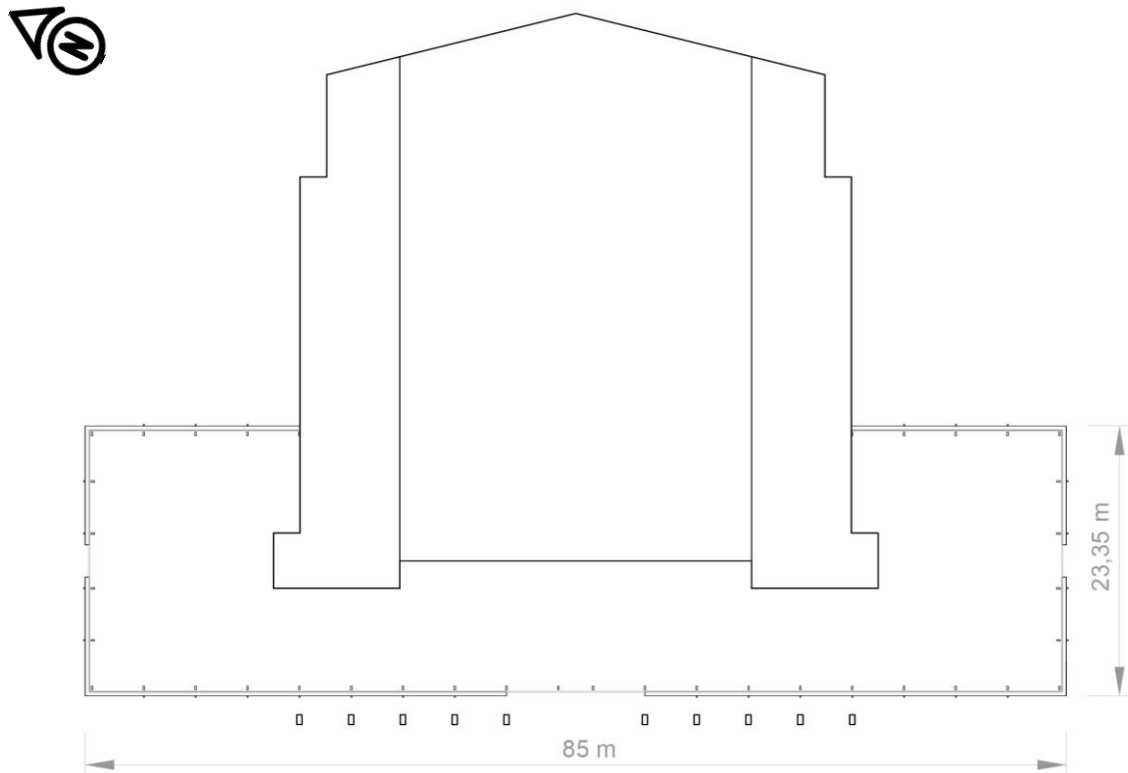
Planta del Palau de la Música (Elaboración propia)
